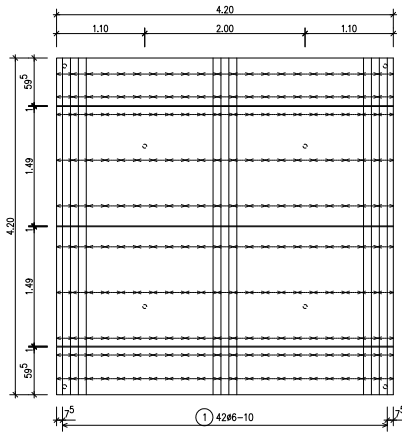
Platten 2 und 3, Bewehrung in Ortbetonergänzung, untere Lage
